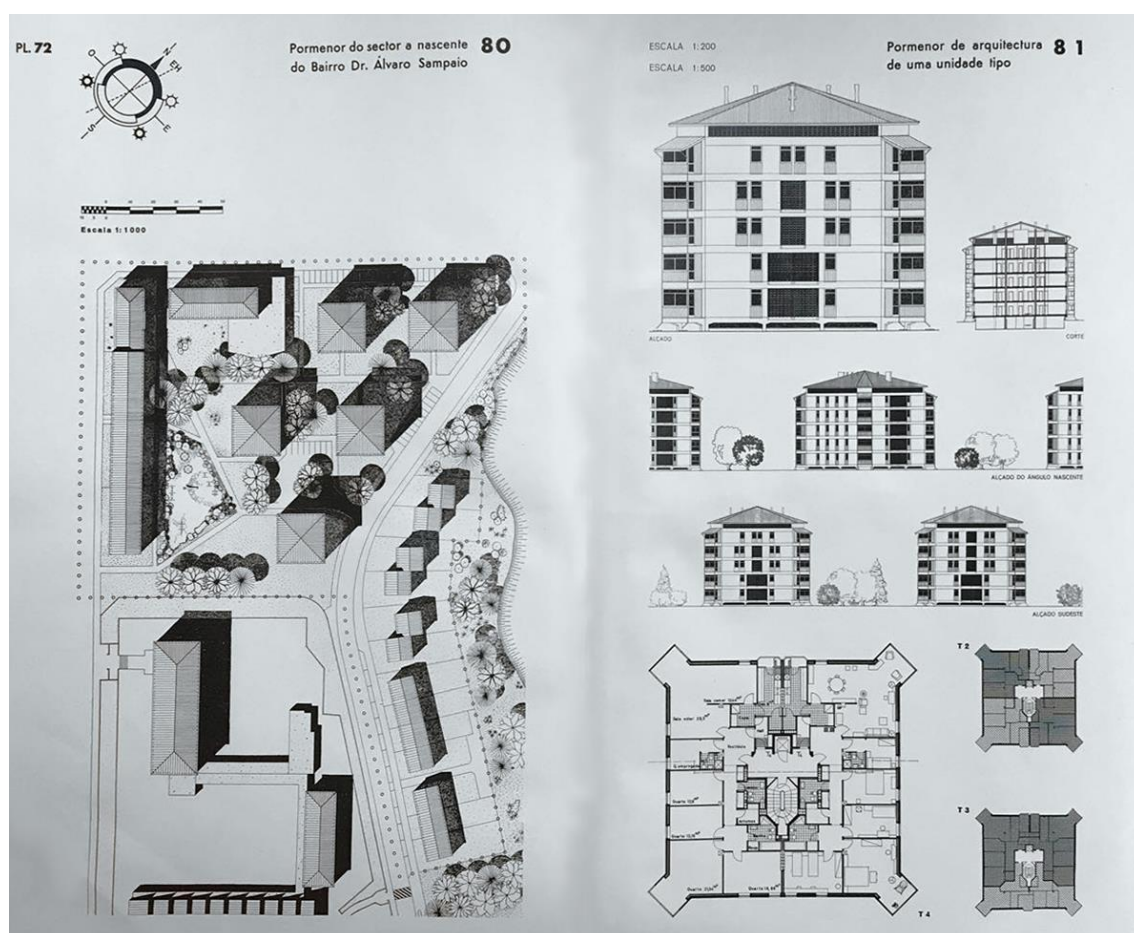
| Pormenor do Sector Nascente, Bairro Dr. Álvaro Sampaio.
